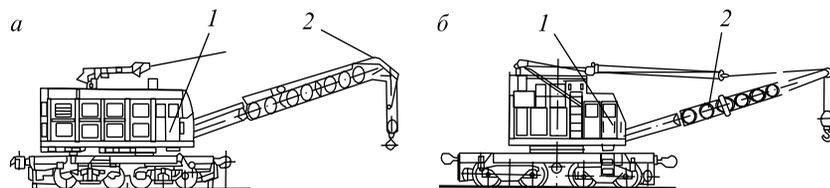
Краны: а — КЖДЭ (КДЭ); б — строительно-монтажный КЖС-16; 1 — кабина управления; 2 — стрела крана
